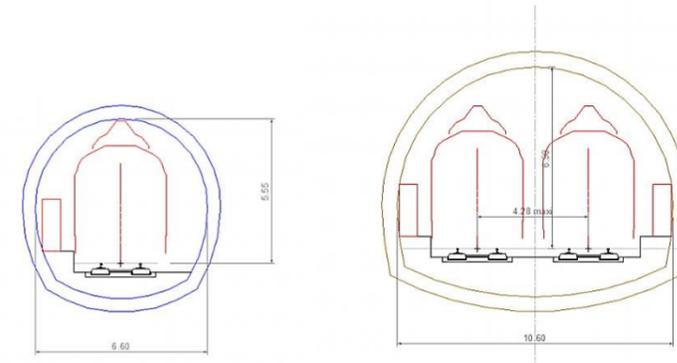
Sections des ouvrages élémentaires de type 1 & 2
